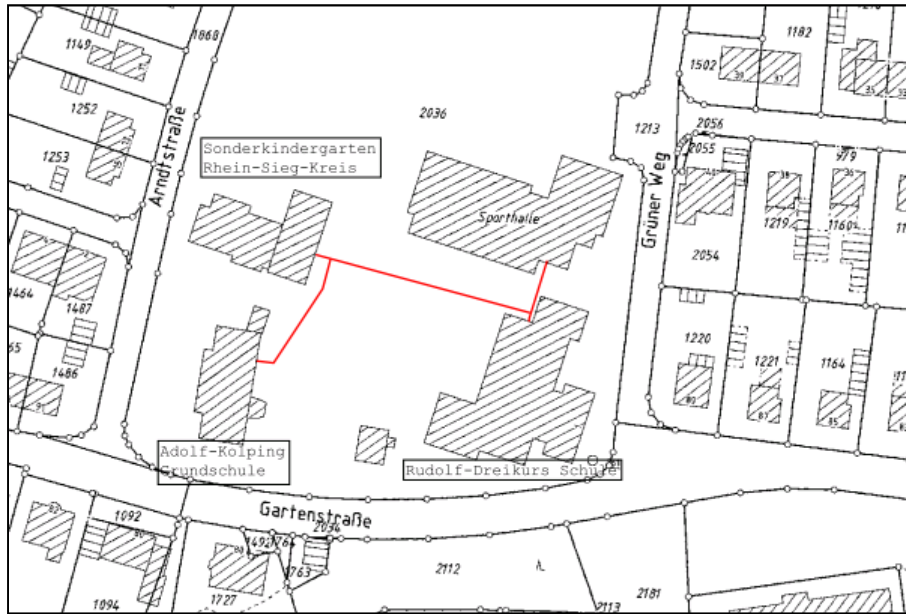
Lageplan Nahwärmenetz im Bereich Arndtstraße/ Grüner Weg
